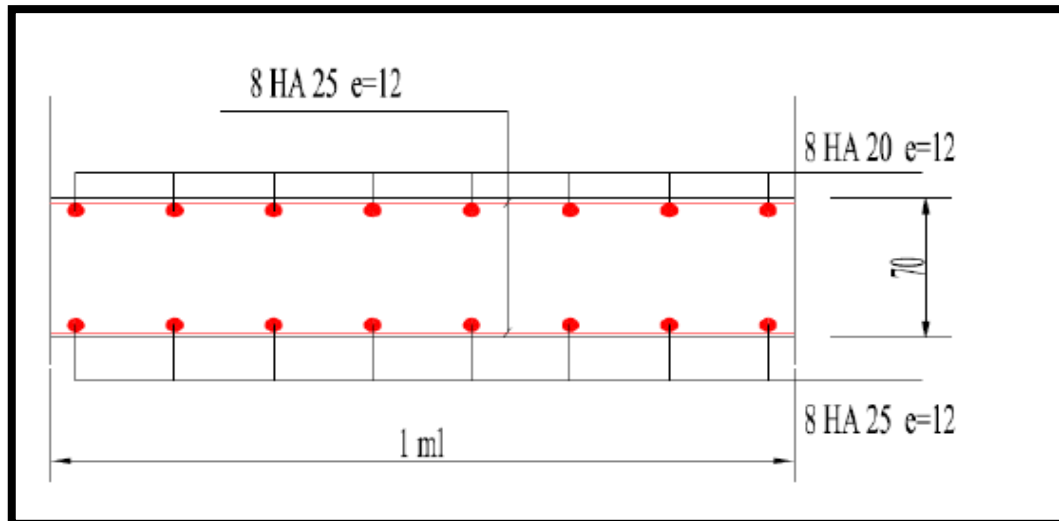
Ferrailage de la dalle du radier (sens xx).
